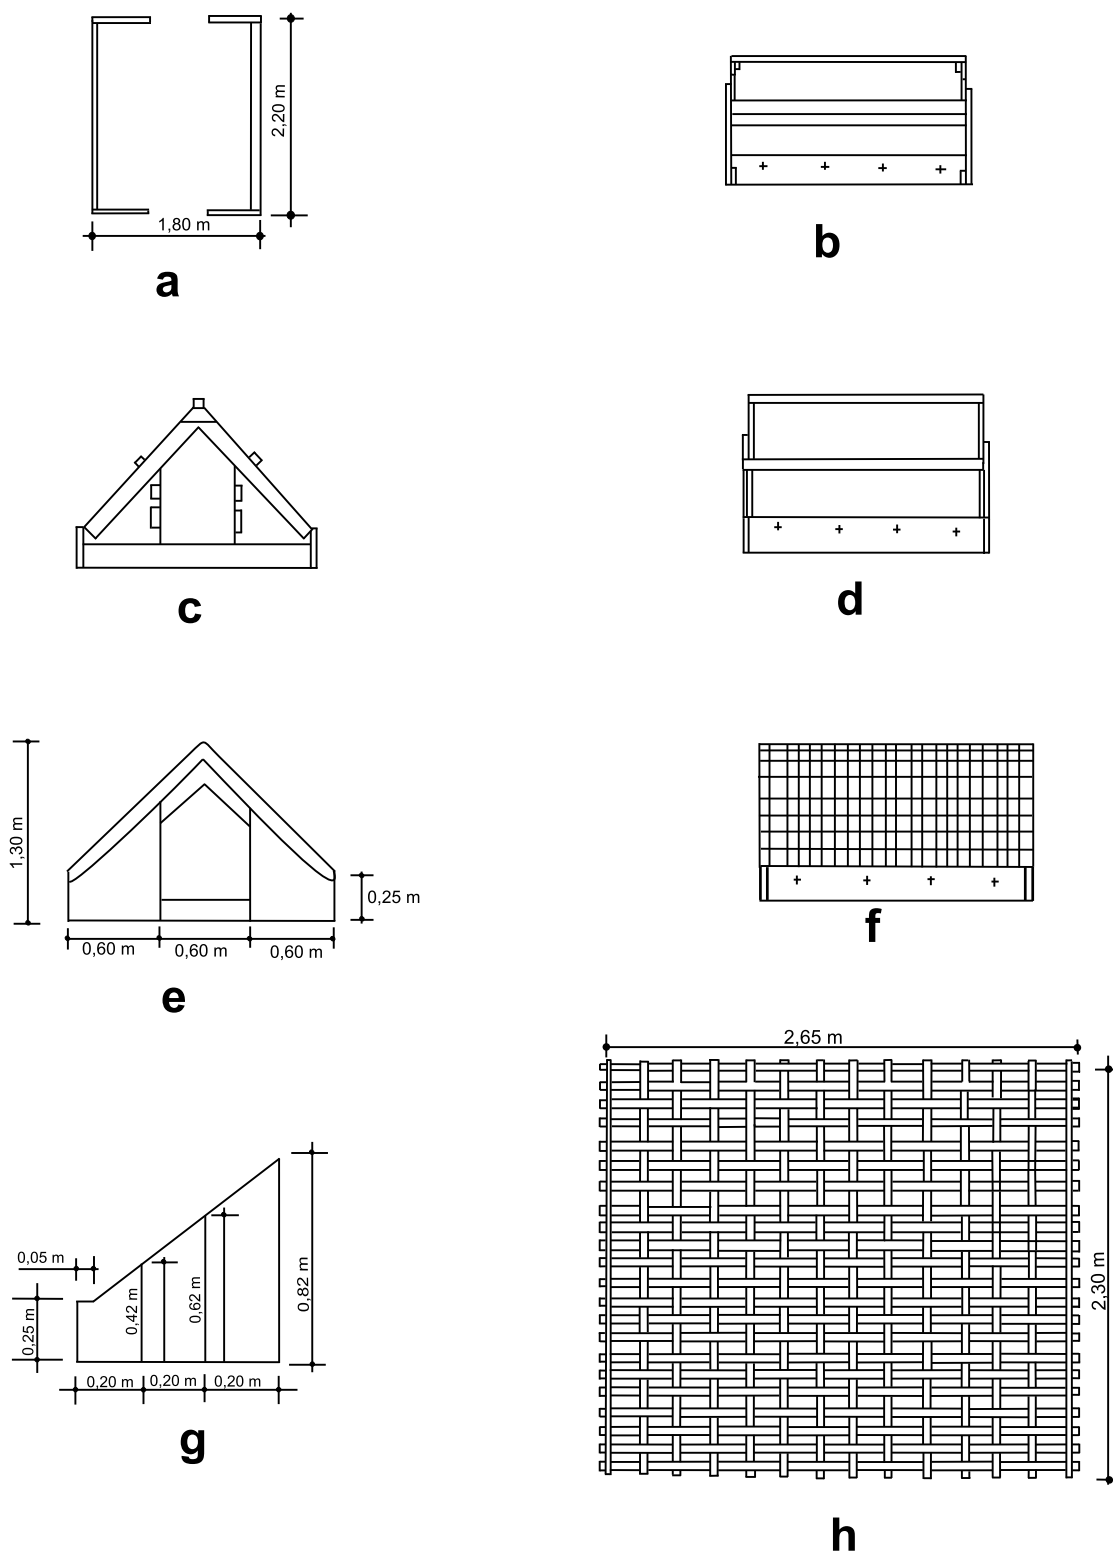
Cabana de maternidade – Tipo Chalé: a) Planta baixa; b) Corte longitudinal; c) Corte transversal; d) Vista lateral – sem cobertura; e) Vista frontal; f) Vista lateral – com cobertura da esteira; g) Detalhe g; h) Esteira de taquara.
